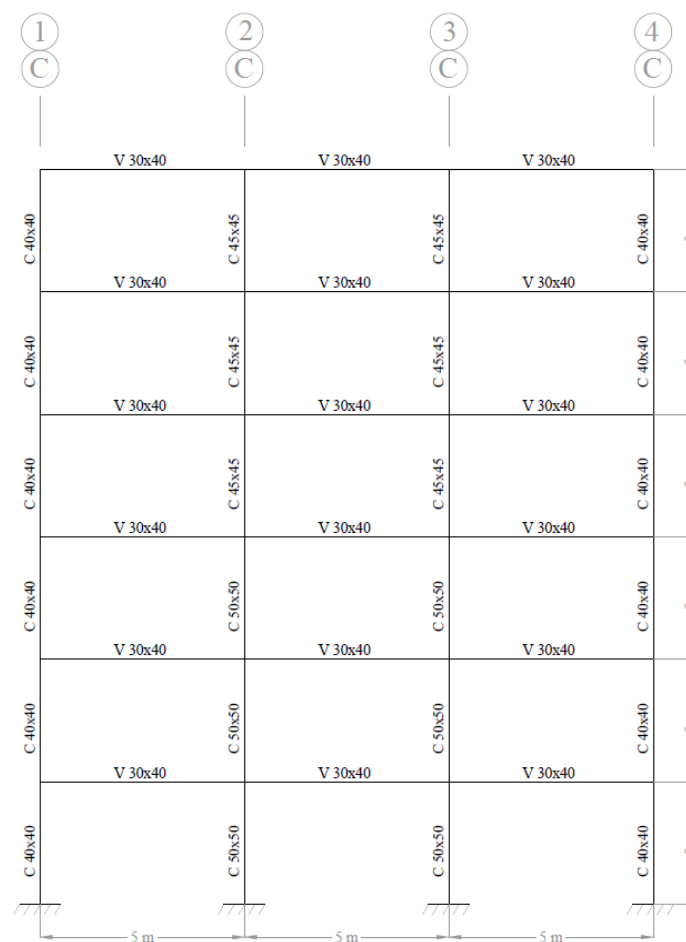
Dimensiones de los elementos estructurales del pórtico 3.
